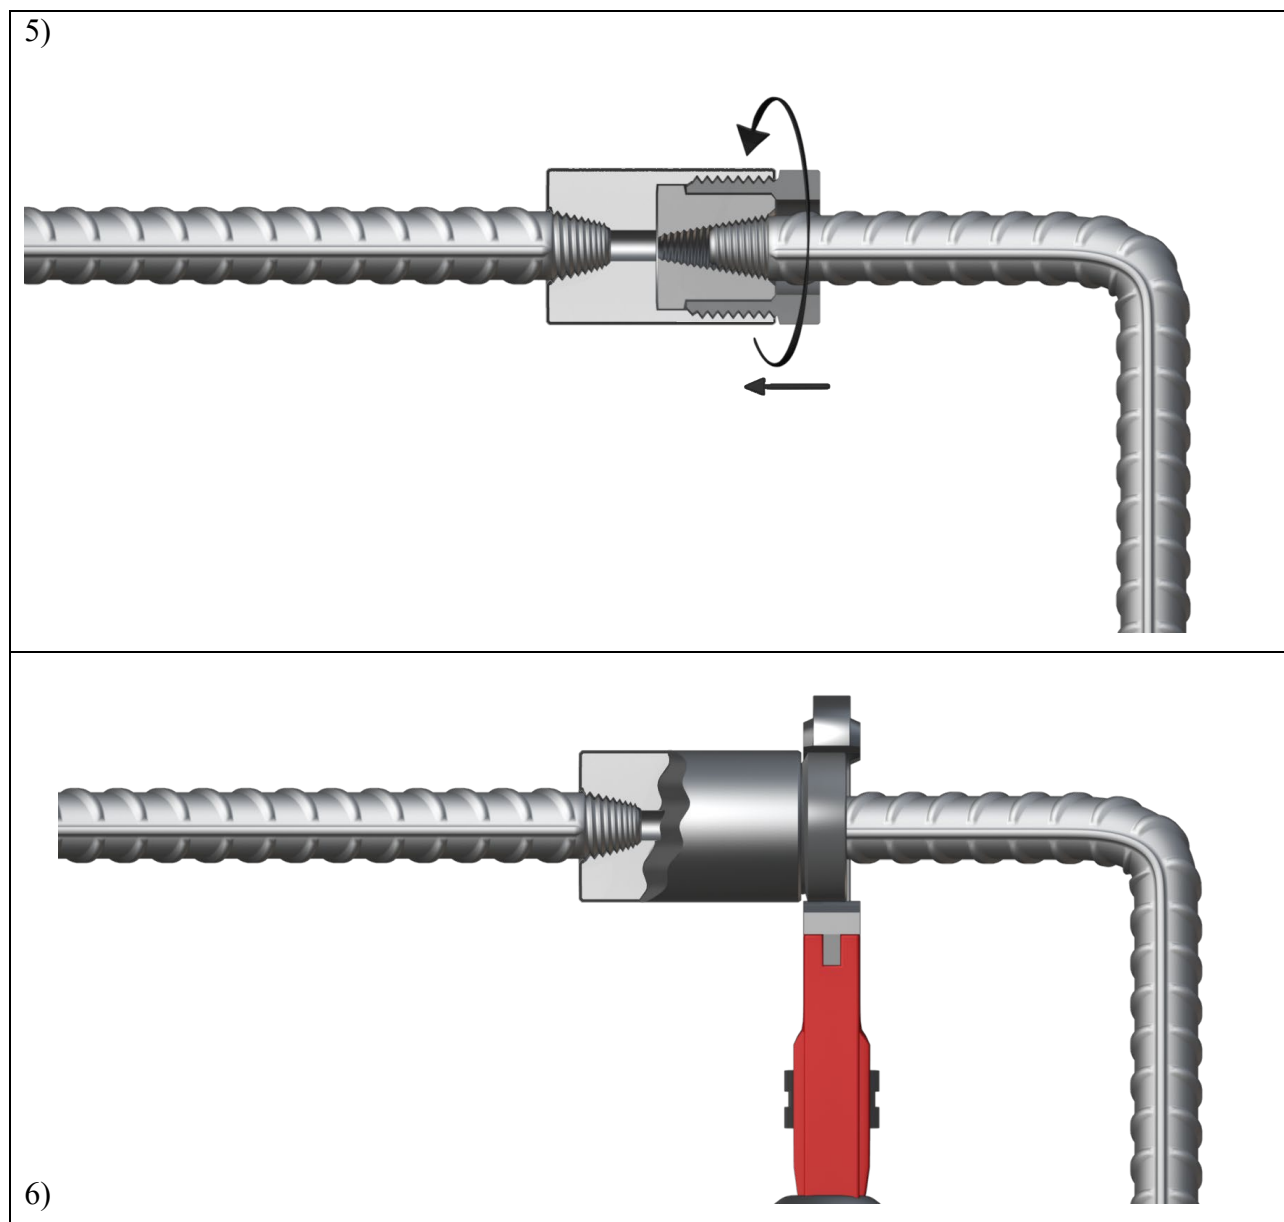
Сборка позиционного соединения тип 2 с конической резьбой
